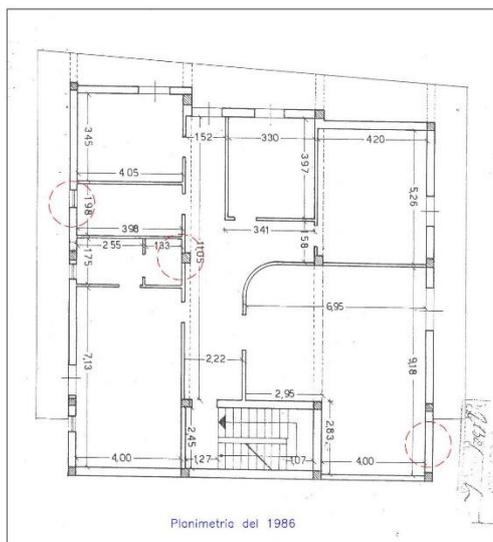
Raffronto tra le planimetrie allegata alla pratica edilizia.
